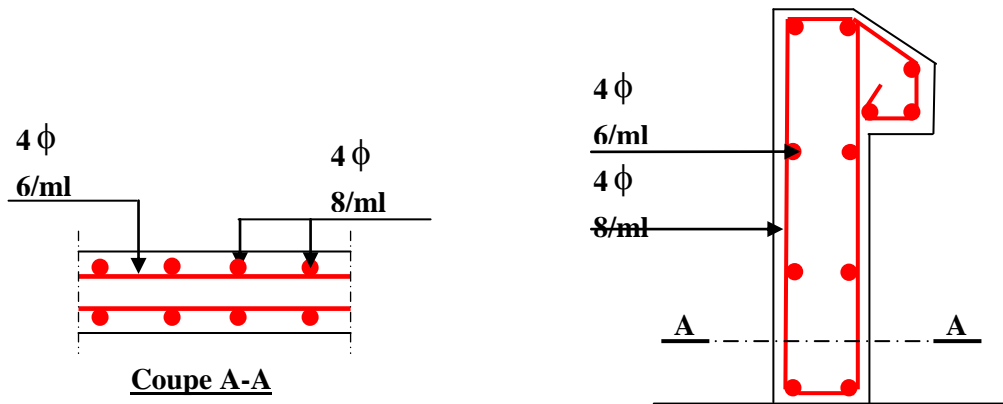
Schéma de ferrailage de l'acrotère (Terrasse inaccessible).
